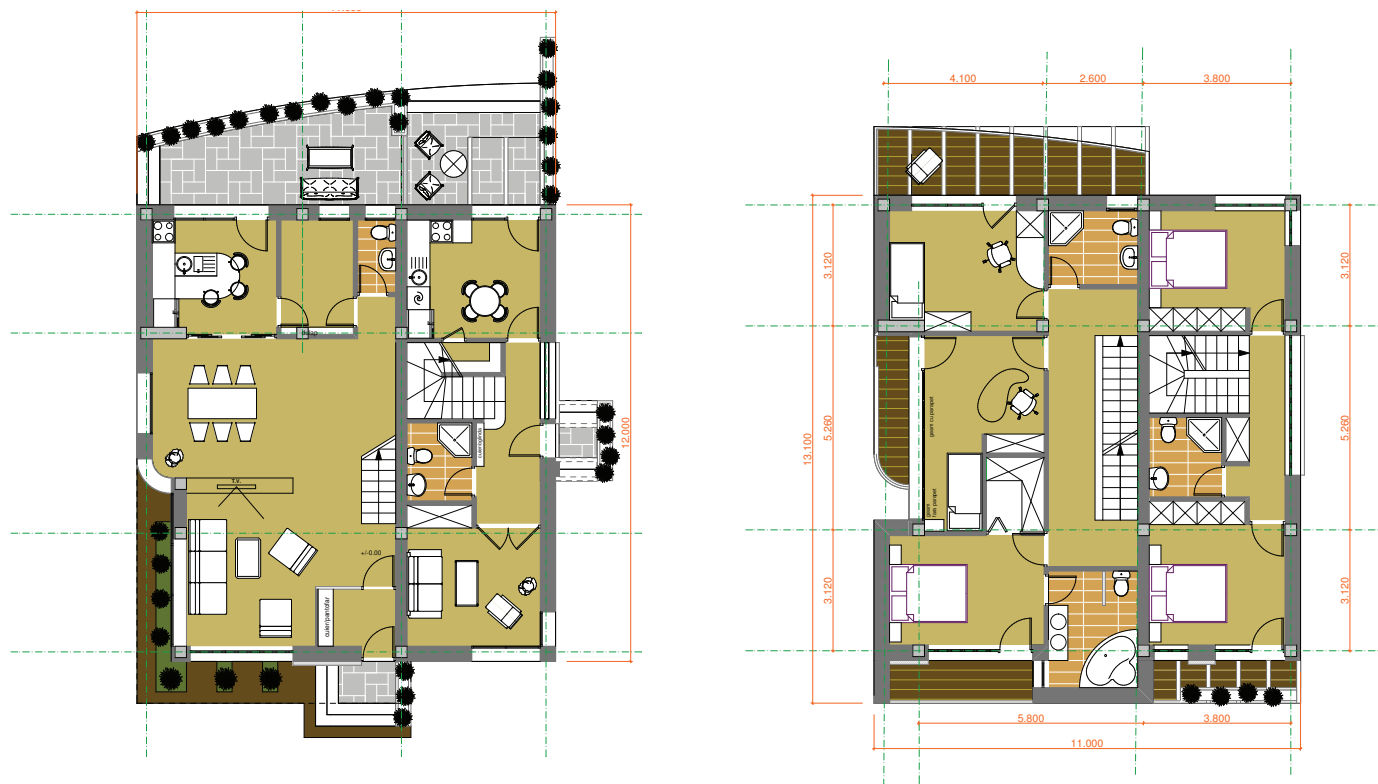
, 19 Plan parter și plan etaj / Ground-floor and level 1 plans
